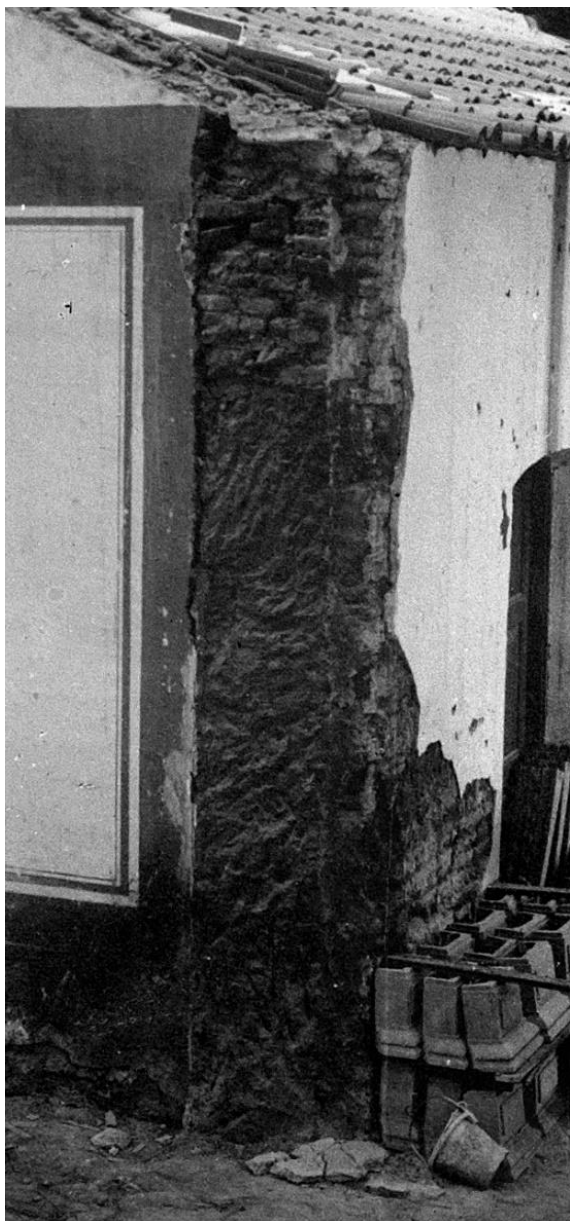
El salón en la obra de 1904 durante la demolición de los locales del pabellón principal. Detalle del corte del muro de tapial recrecido con adobes en el tramo superior y recalzado con adobes en el nivel inferior para reconstituir la masa muraria degradada por la acción de la humedad ascendente y de la erosión de origen pluvial a partir de 1879. MOP 1904. IAA
